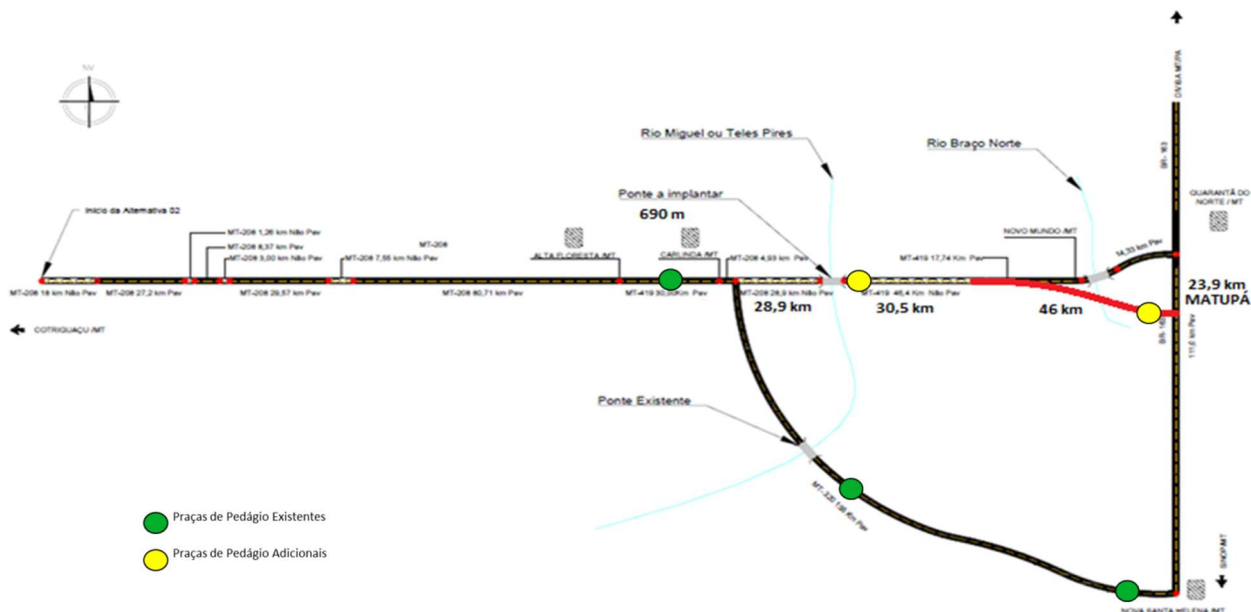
Alternativas de traçado para ligação com a BR-163 (Matupá)
